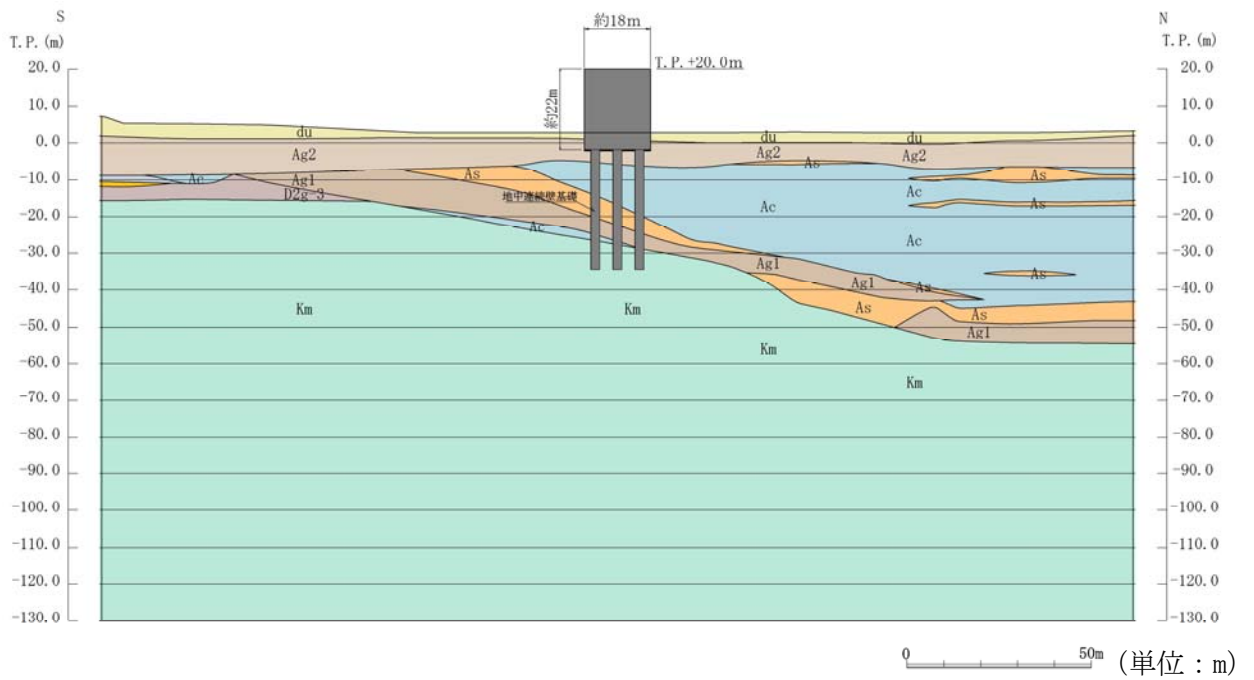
(3) 鉄筋コンクリート防潮壁 評価対象断面図 (③-③断面)
